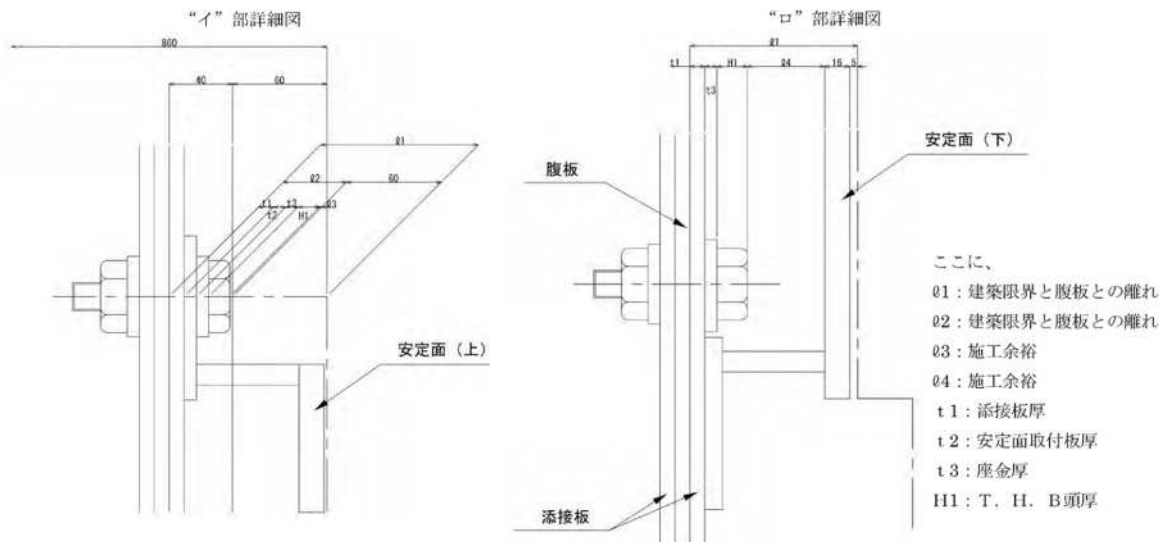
10 添接位置及び安定面取付け位置での施工余裕（設定カントなし）
